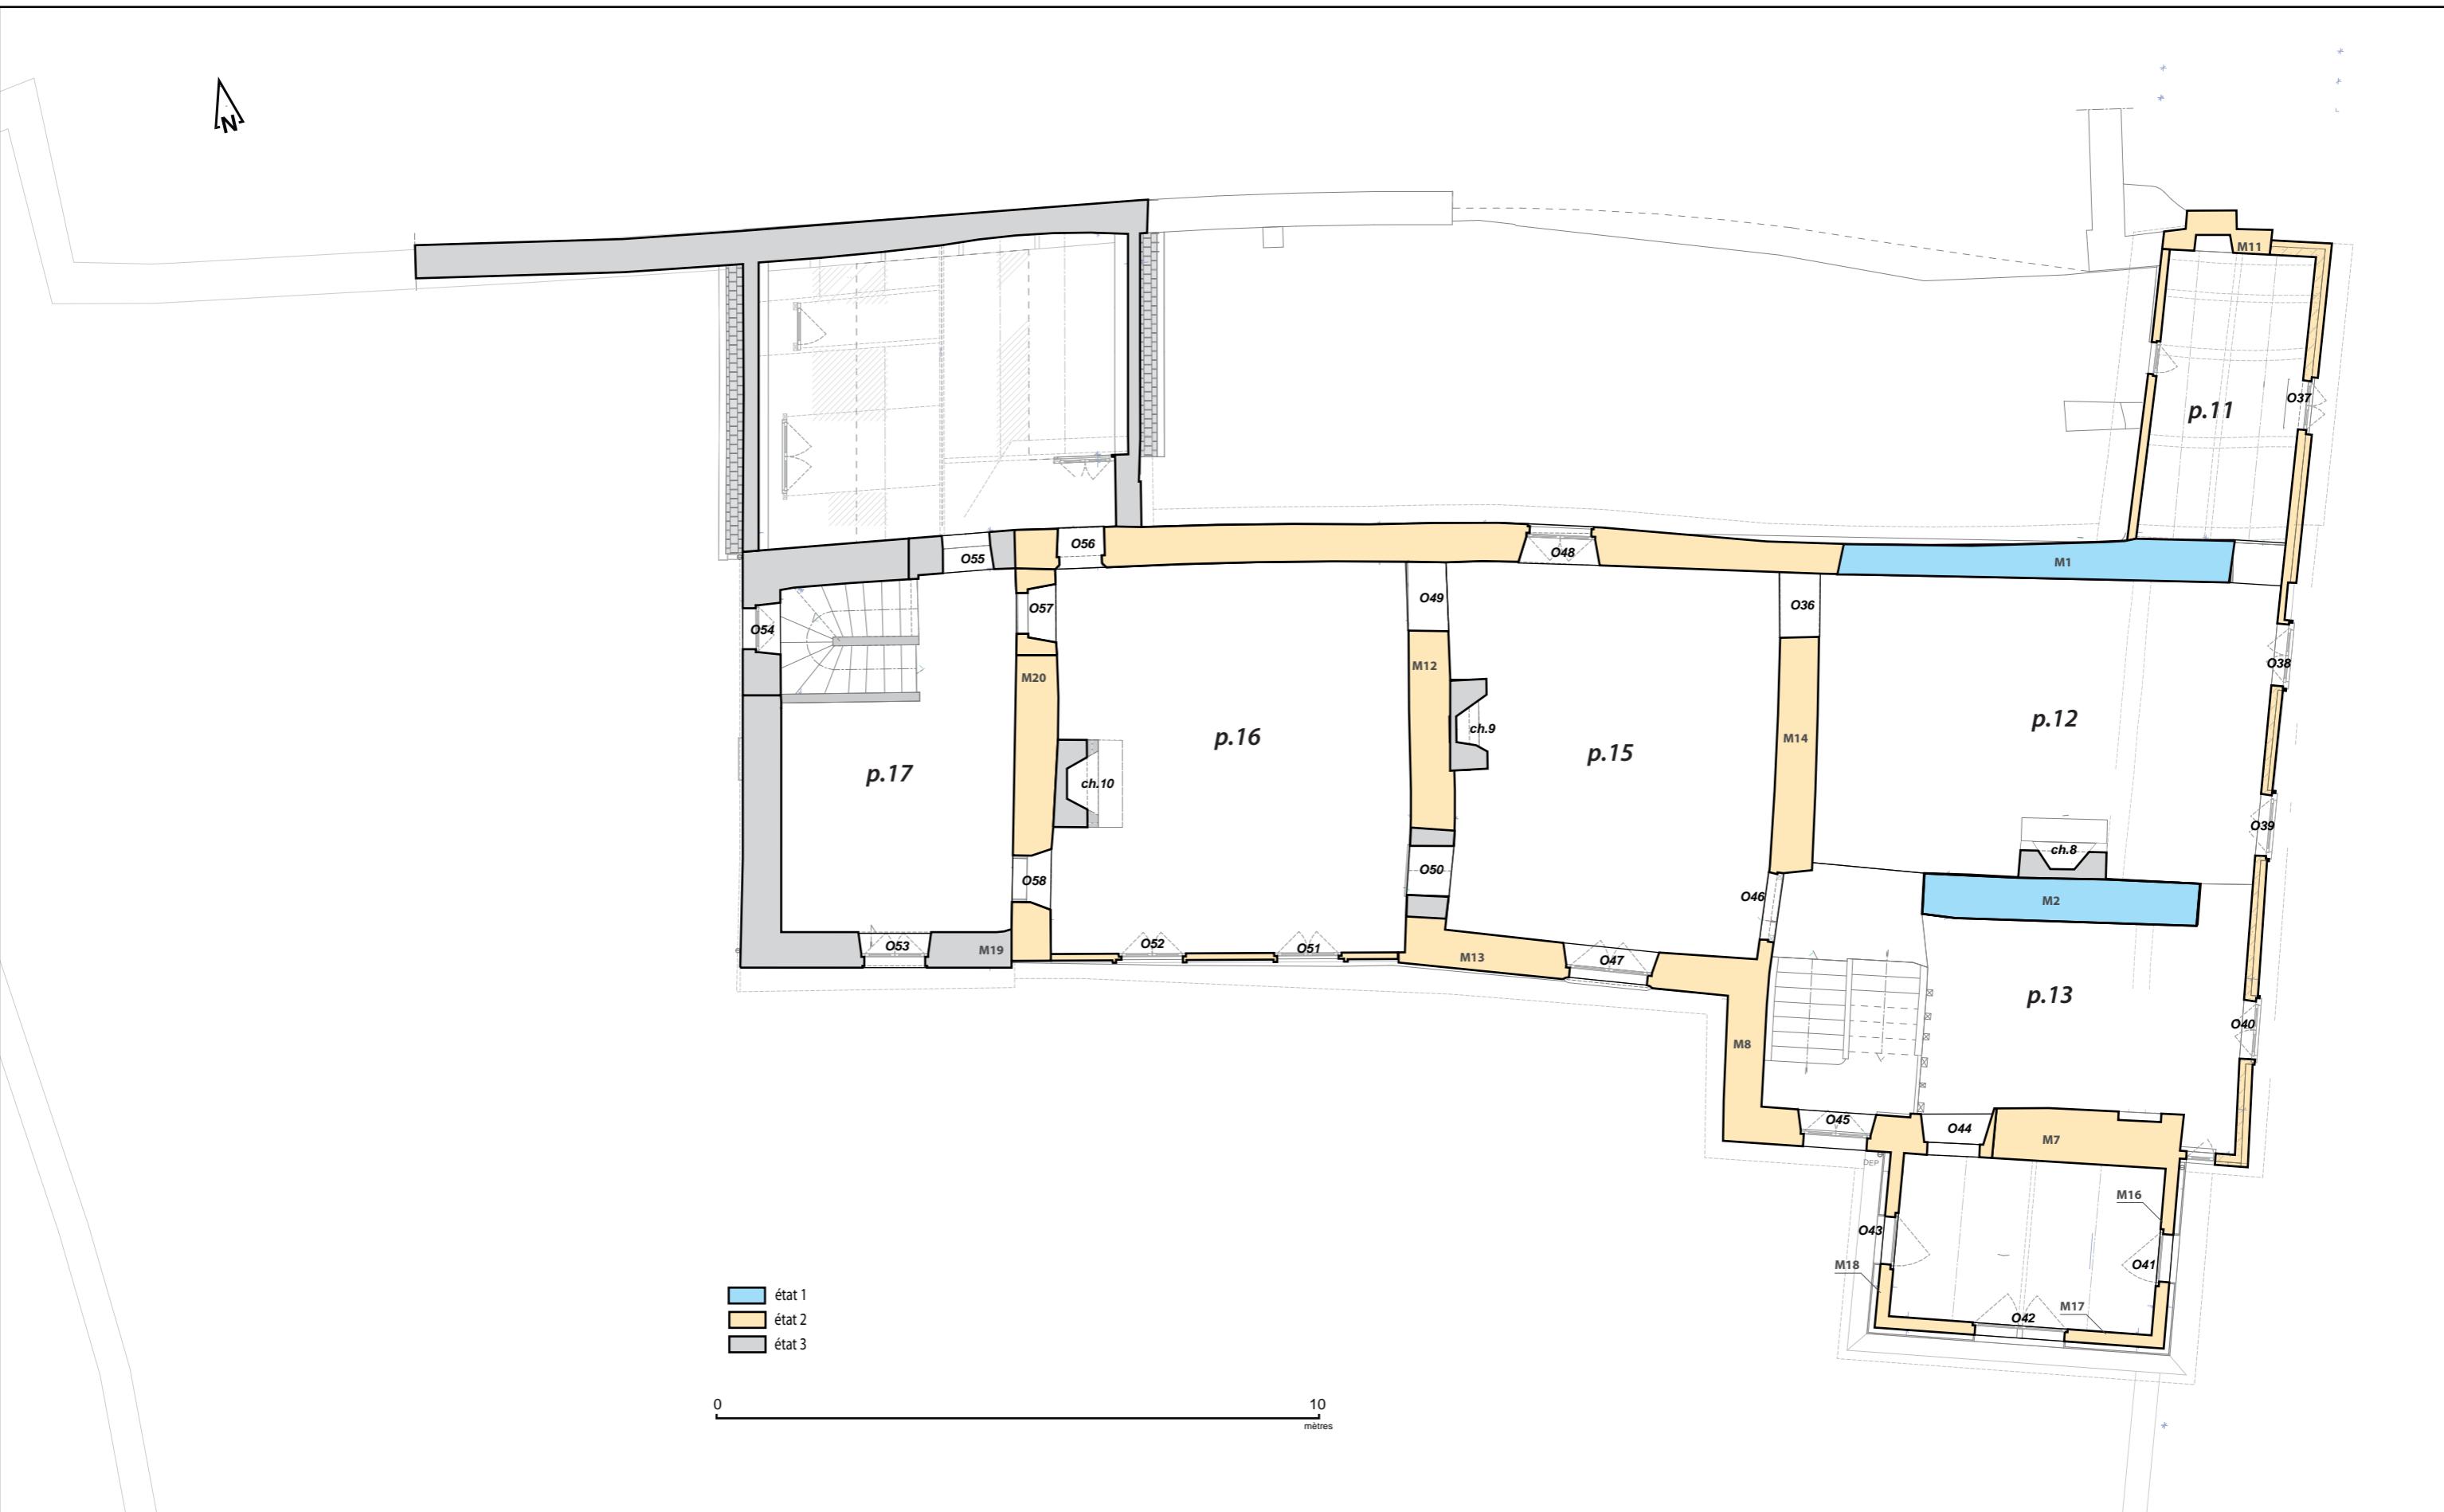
plan phasé du 2ème étage © T. Béthus, Inrap (fond de plan architecte trace et associés)
